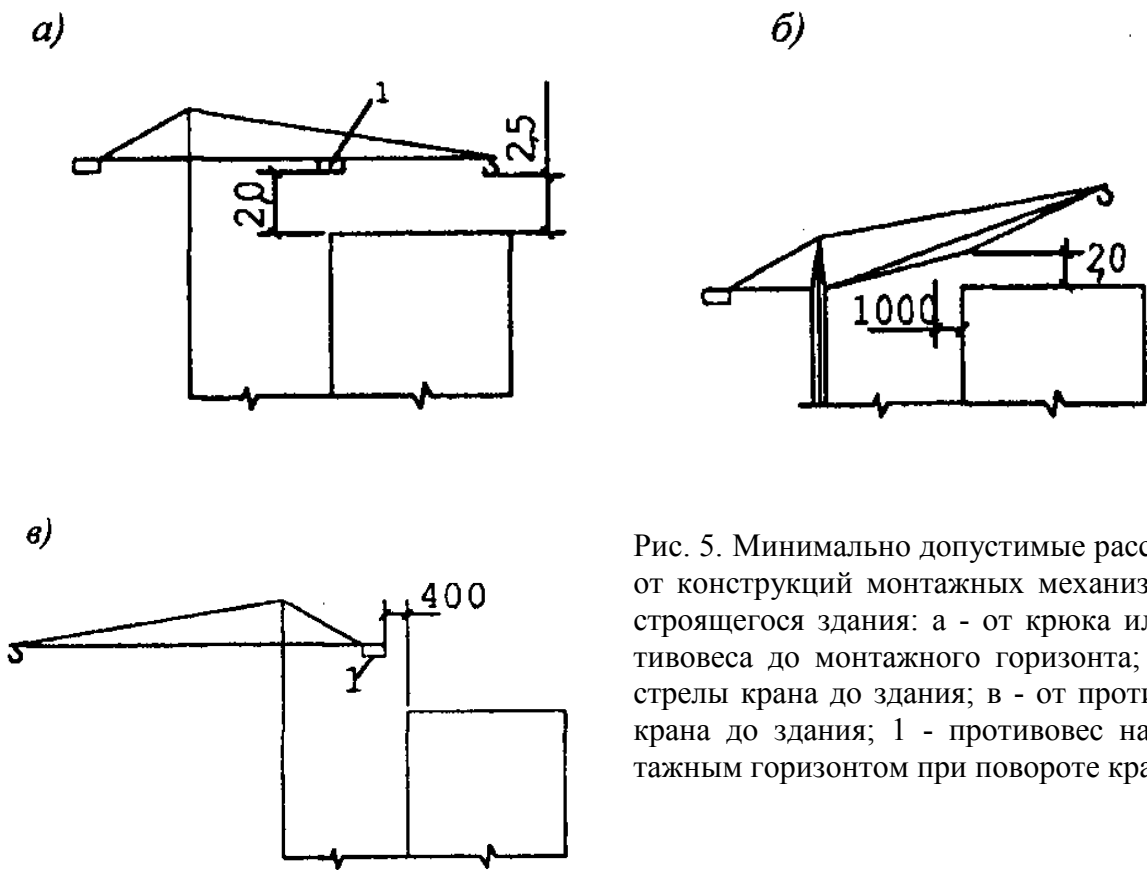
Минимально допустимые расстояния от конструкций монтажных механизмов до строящегося здания: а - от крюка или противовеса до монтажного горизонта; б - от стрелы крана до здания; в - от противовеса крана до здания; 1 - противовес над монтажным горизонтом при повороте крана
